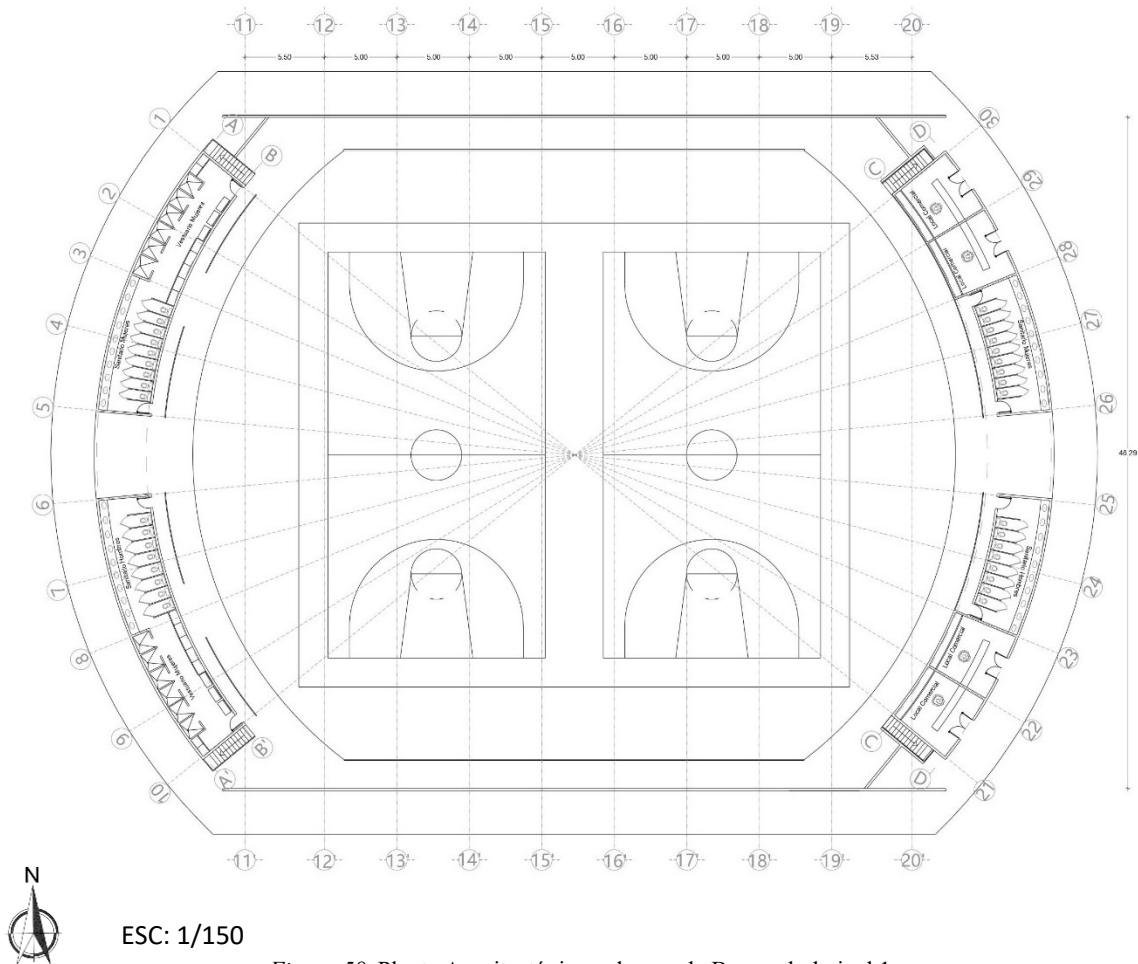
Planta Arquitectónica volumen de Basquetbol nivel 1.
